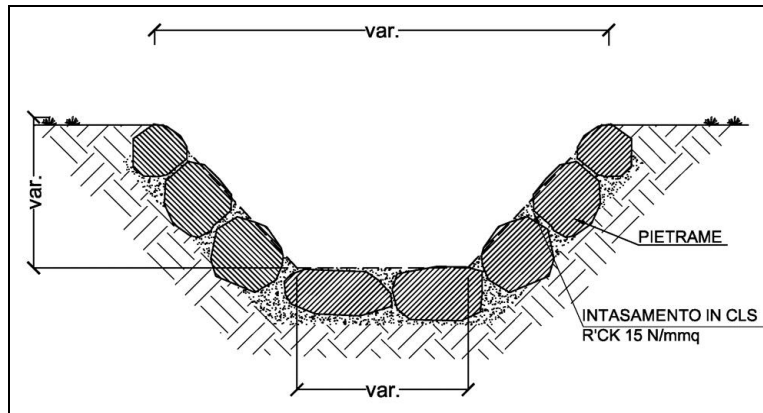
Sistema compluvio sud – Sezione in massi cementati
